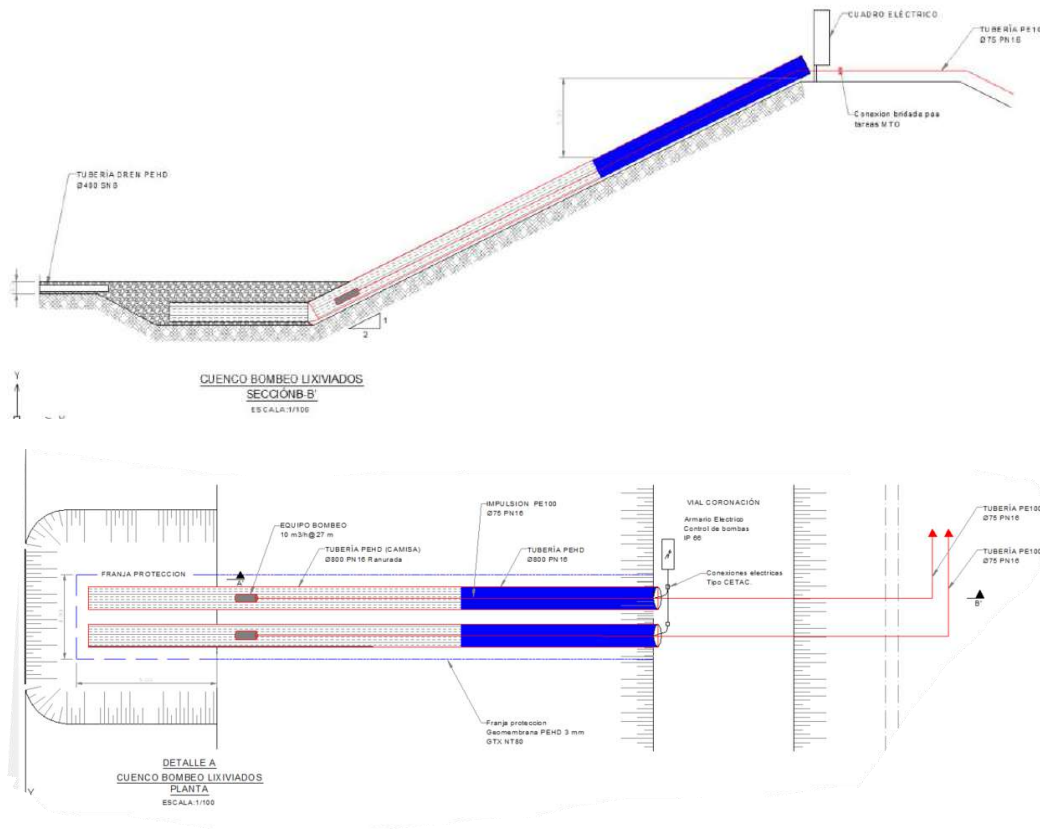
Detalle sistema de recogida y drenaje de lixiviados
